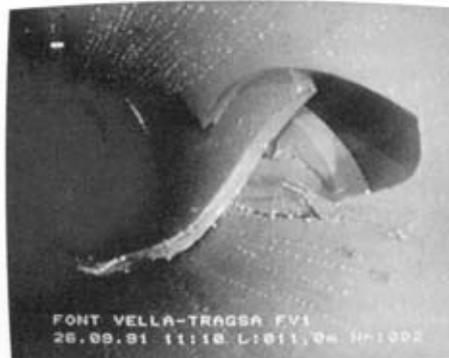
Detalle de sondeo entubado con tubería de PVC inutilizado por colapso mecánico (foto TRAGSATEC).
